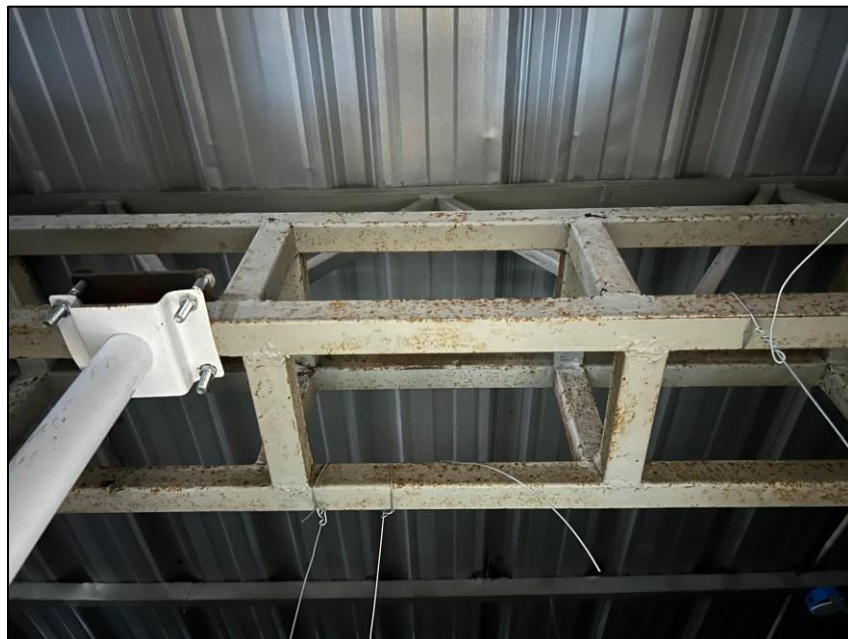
Se muestra el avance del óxido generalizado en las vigas metálicas.
